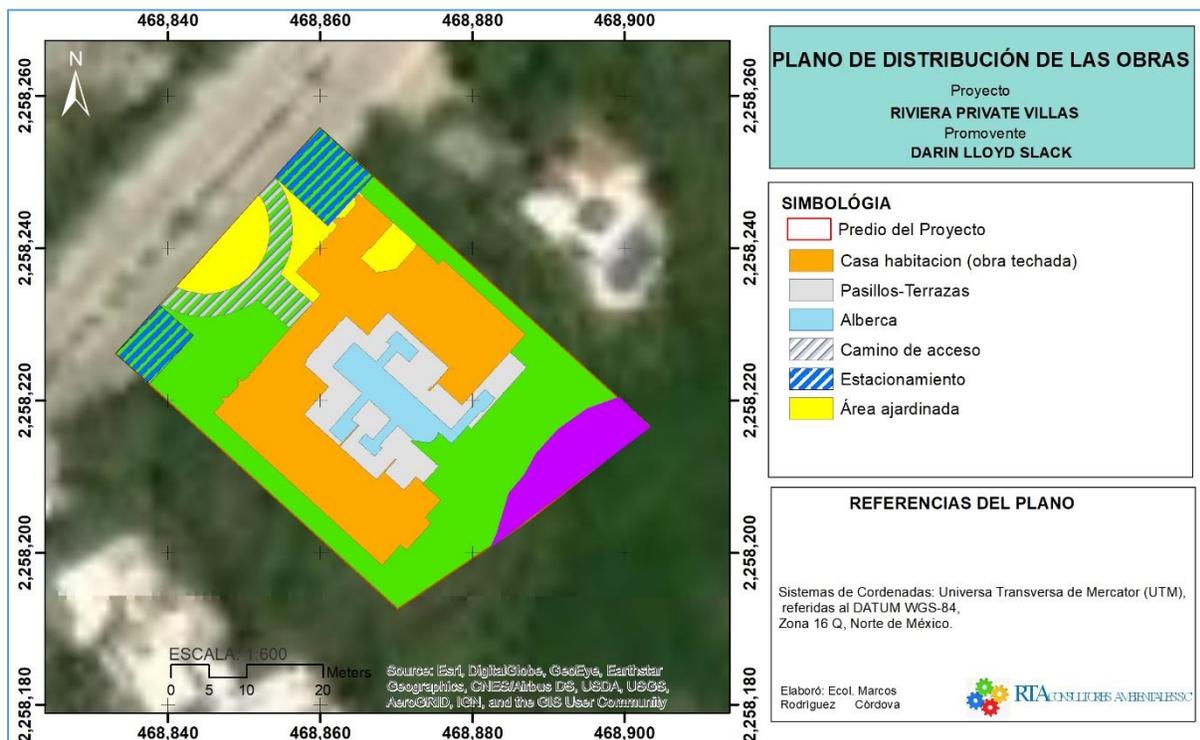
Se muestra en plano de distribución de los componentes del proyecto
